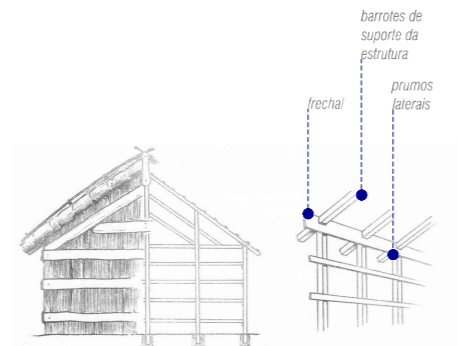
| Alçado e pormenor da construção de uma cabana.
